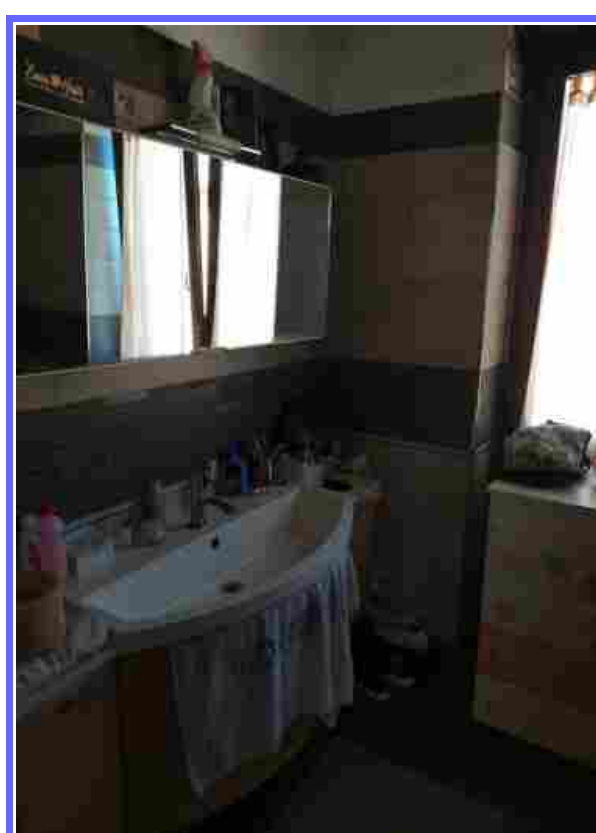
BAGNO PIANO PRIMO - VISTA 1
